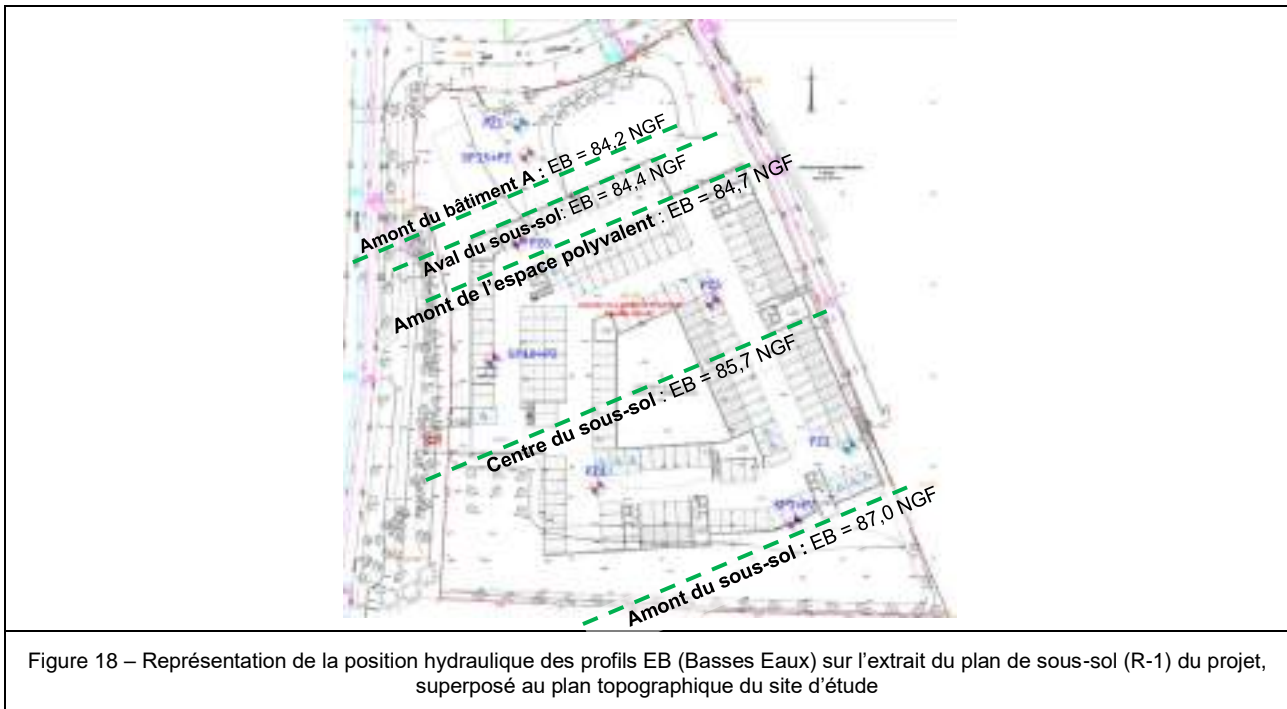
Représentation de la position hydraulique des profils EB (Basses Eaux) sur l'extrait du plan de sous-sol (R-1) du projet, superposé au plan topographique du site d'étude
